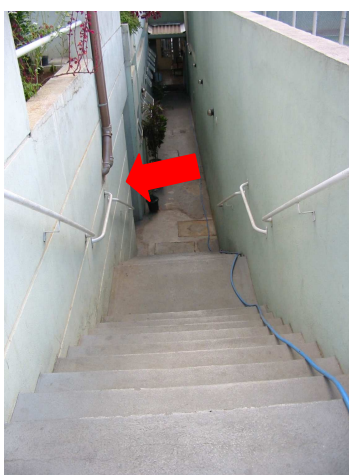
B e 7C – Escada principal de acesso. Entrada do elevador de cadeirantes.
